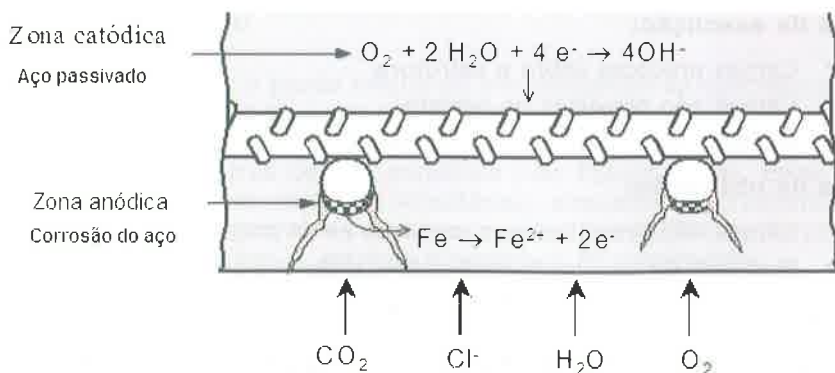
Representação esquemática do processo eletroquímico de corrosão das armaduras no concreto
